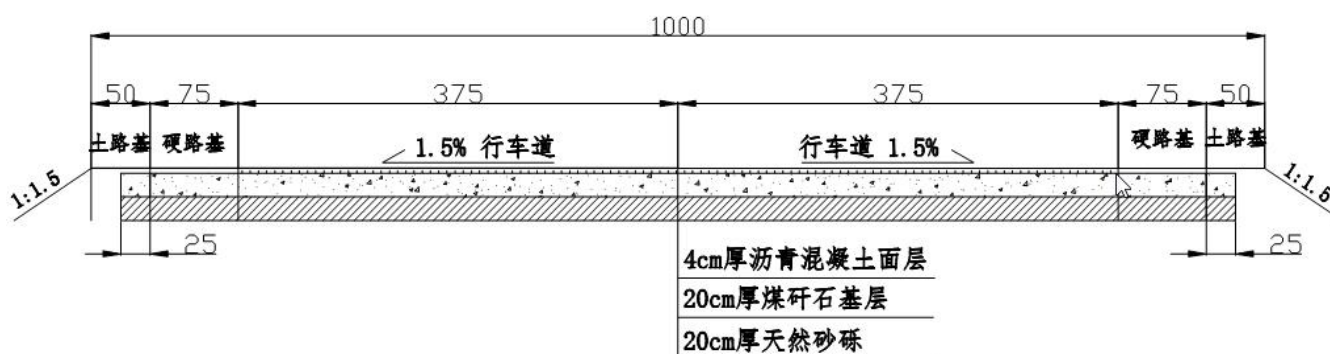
东胜区—准格尔旗公路剖面图（单位：cm）
